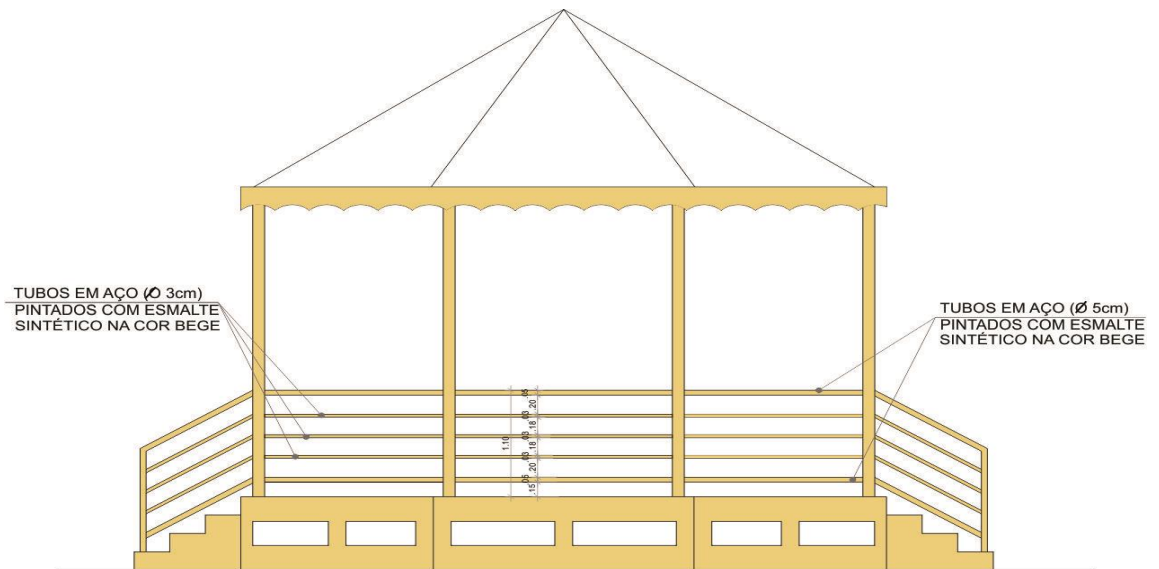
Vista lateral do coreto com a indicação das barras de ferro do guarda-corpo.
